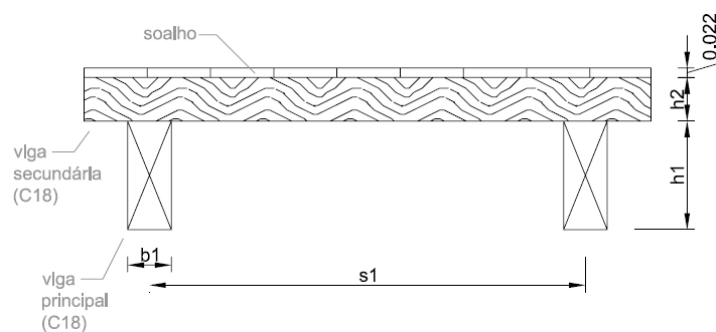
Esquema da solução de madeira maciça S1-B (corte transversal).
